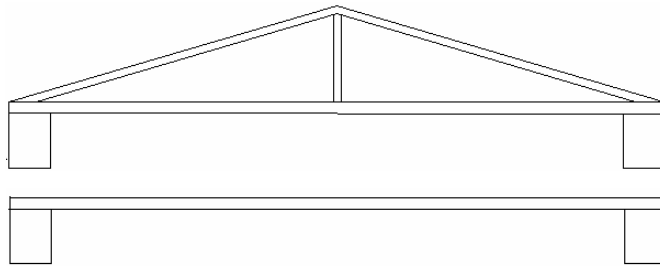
Cubierta estable o plana con viga de soporte. Fuente: Autores de proyecto.
